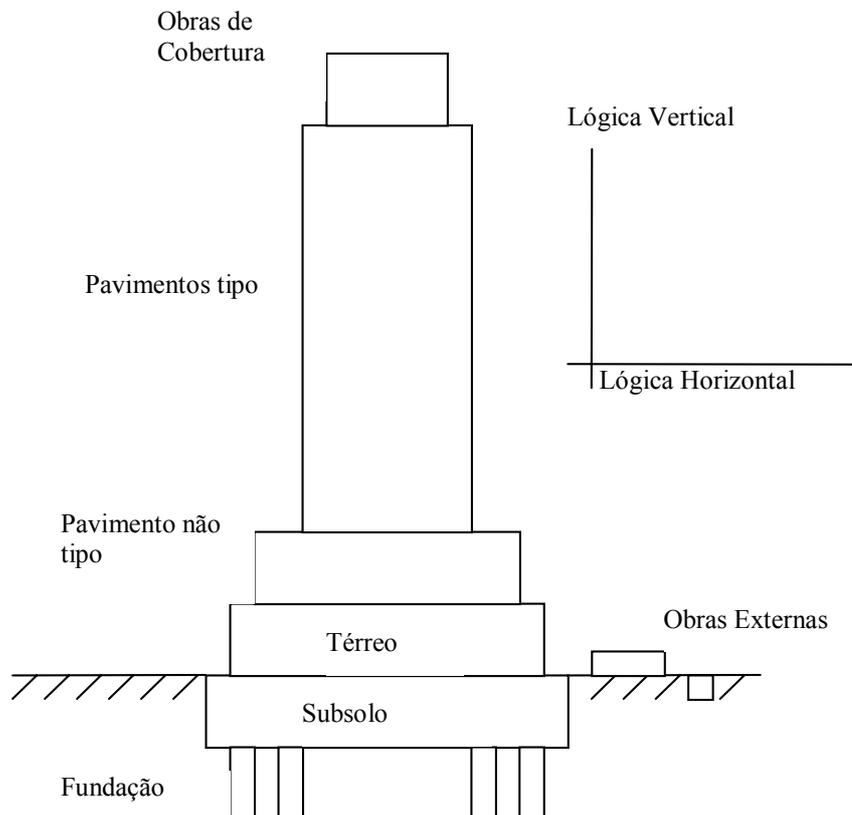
Sistematização funcional geral dos edifícios dotados de pavimentos tipo.
